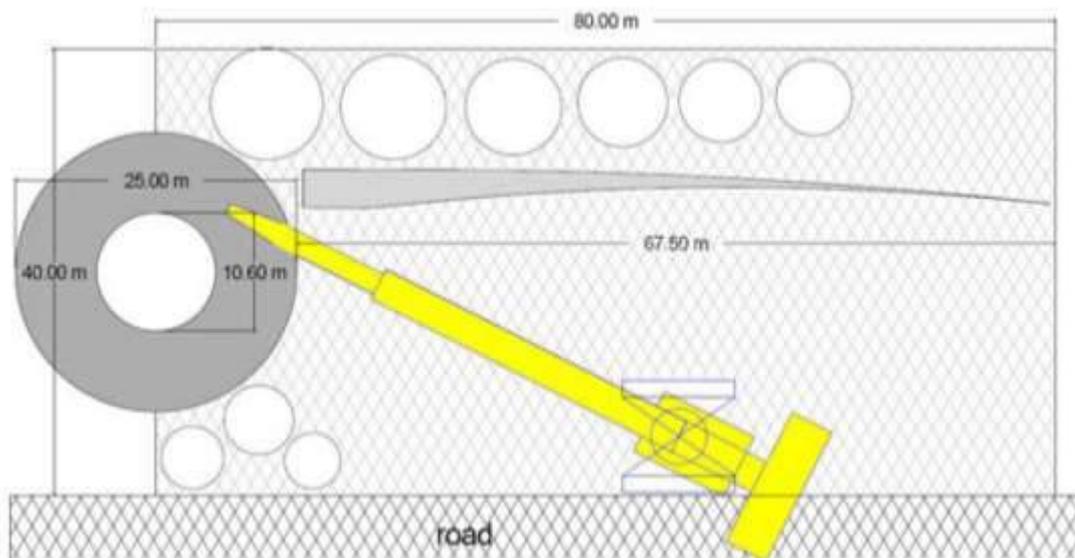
Vista en planta de fundación y locación para grúas y almacenamiento.
